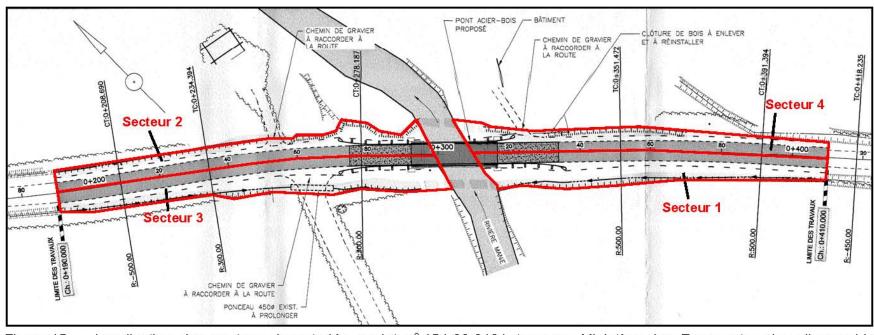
Localisation des secteurs inventoriés, projet nº 154-96-0191 (source : Ministère des Transports, plan d'ensemble [extrait], Plan et profil de la route, Plan PO-2010-1-17596 (3/8), 23 juillet 2010)
